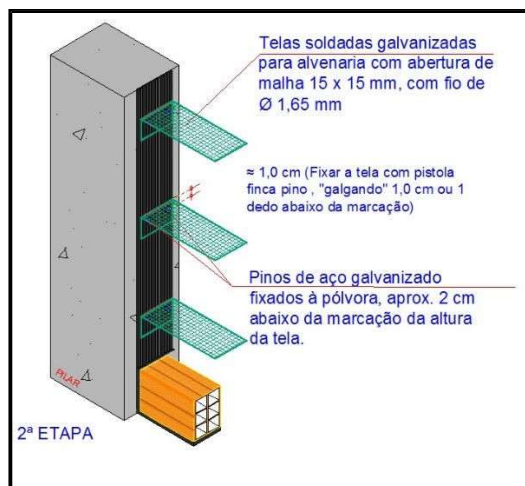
Detalhe da amarração da alvenaria nos pilares.
